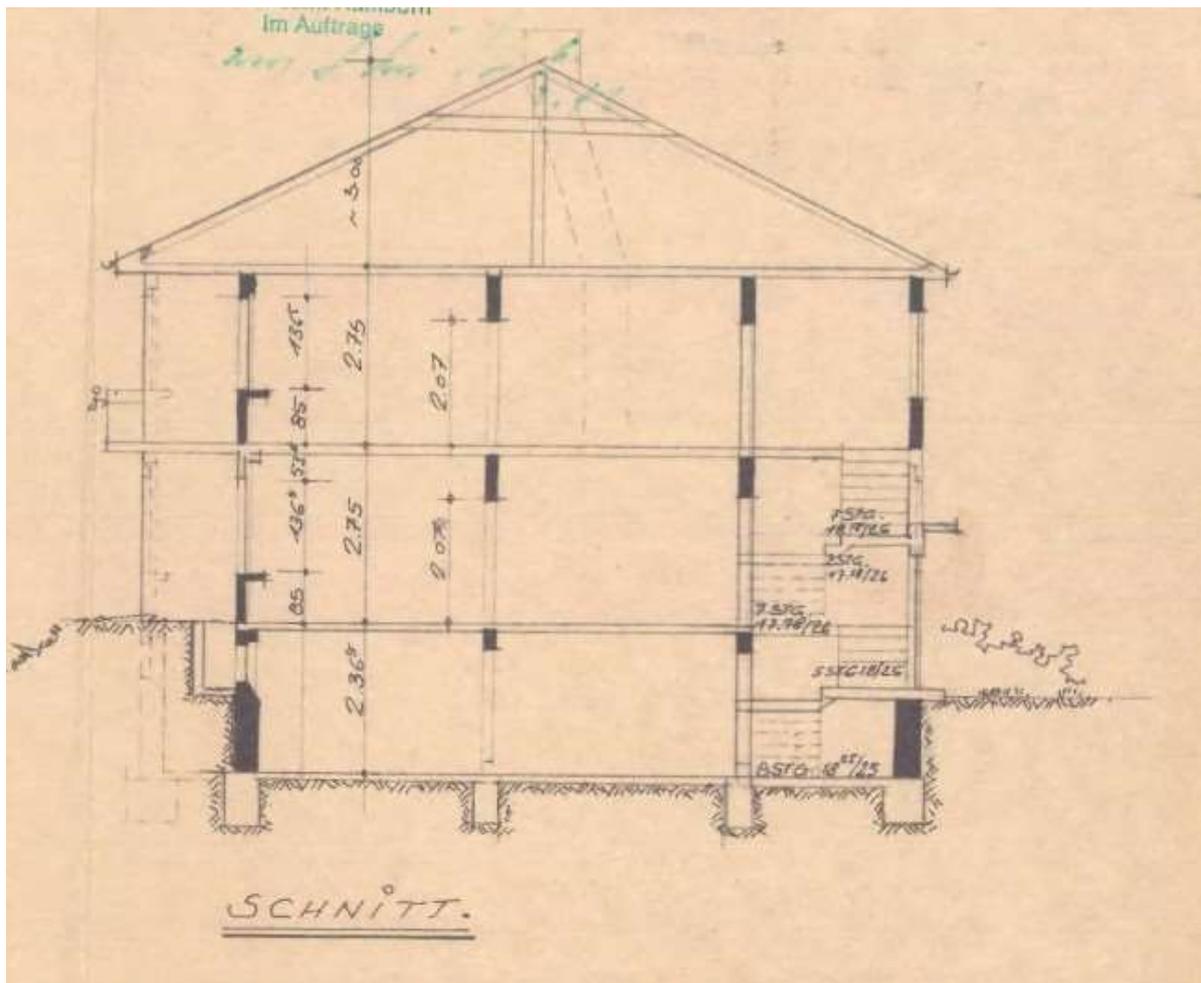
Grundrisse/Ansichten/Schnitt Quelle: Bauakte der Stadt Duisburg
